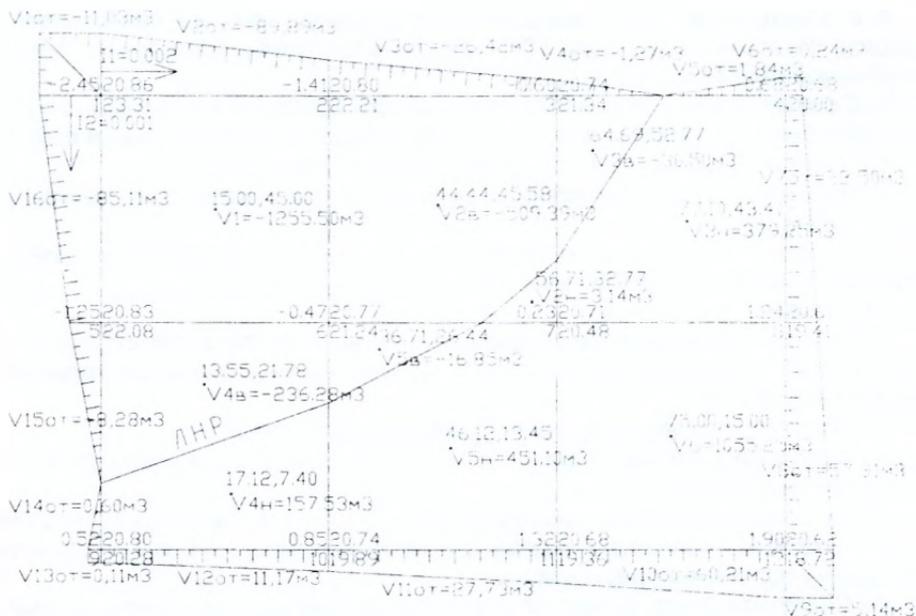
Схема площадки с объемами грунтовых масс, вычисленными способом квадратных призм
